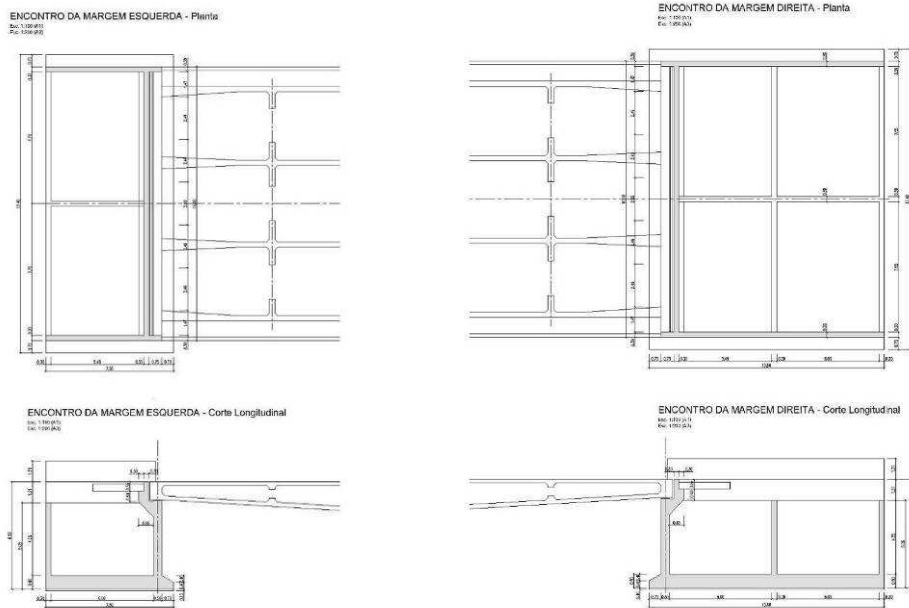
e Fig. 9 – Encontros da Margem Esquerda e Direita: plantas e cortes
